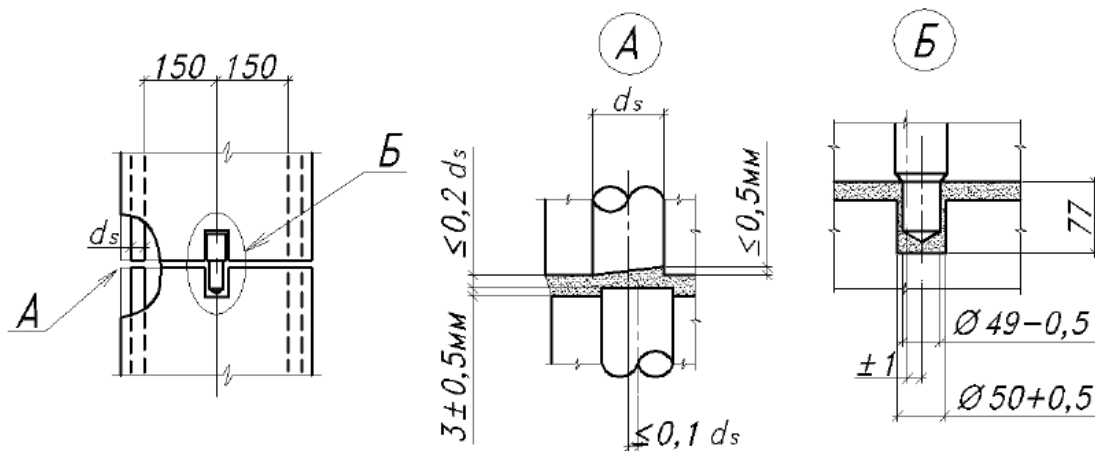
Схема плоского бессварочного стыка и допуски на изготовление и монтаж
